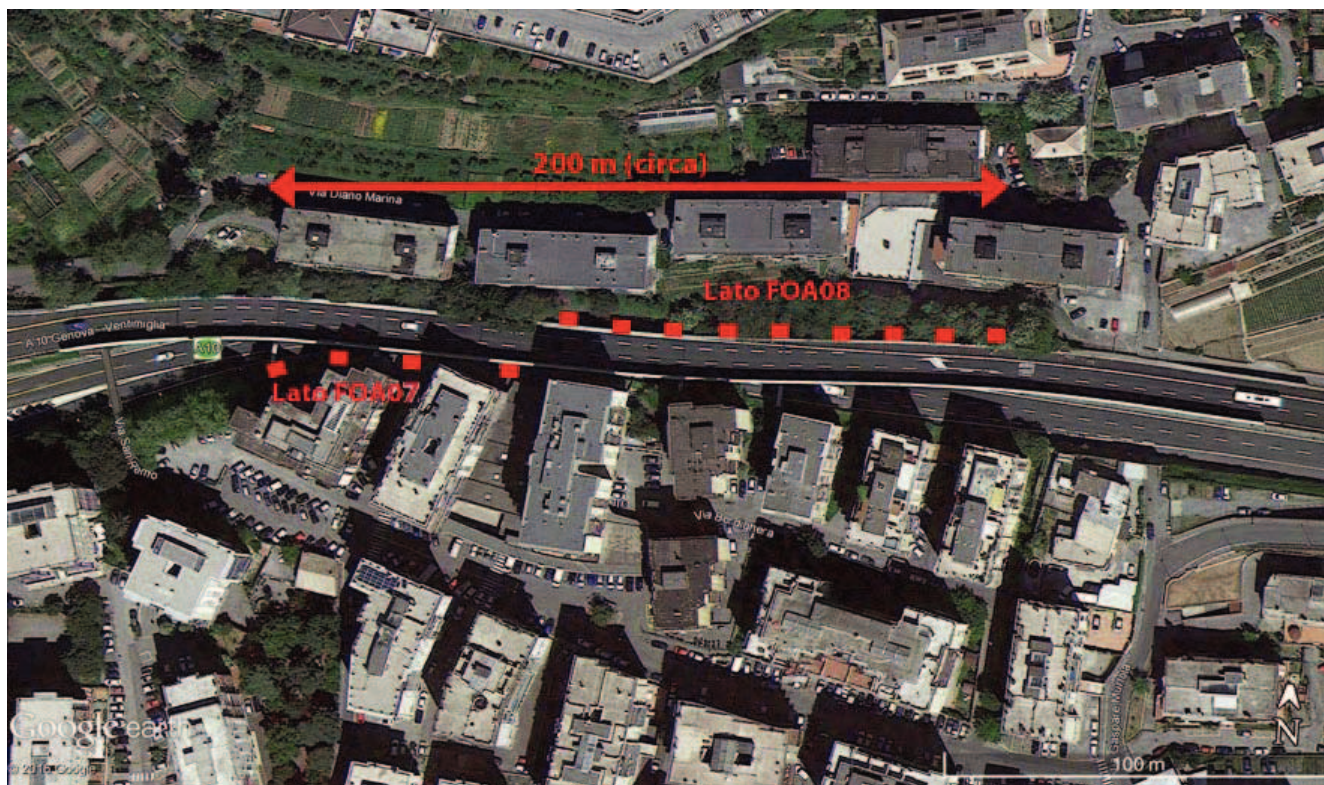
Schema (indicativo) planimetrico di installazione dei dispositivi evacuatori di fumo e calore
